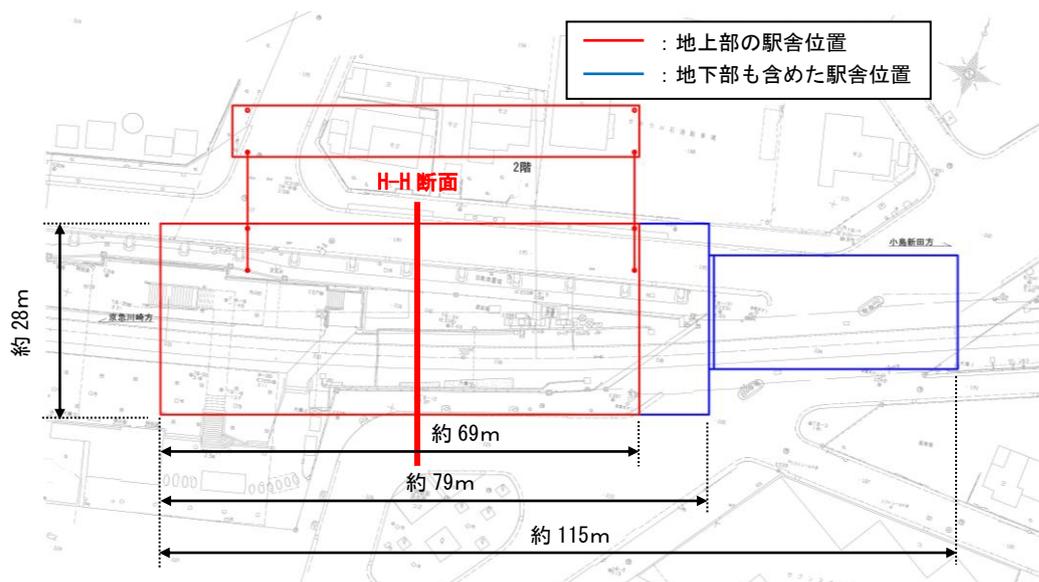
(3) 駅部平面図 (川崎大師駅部)
